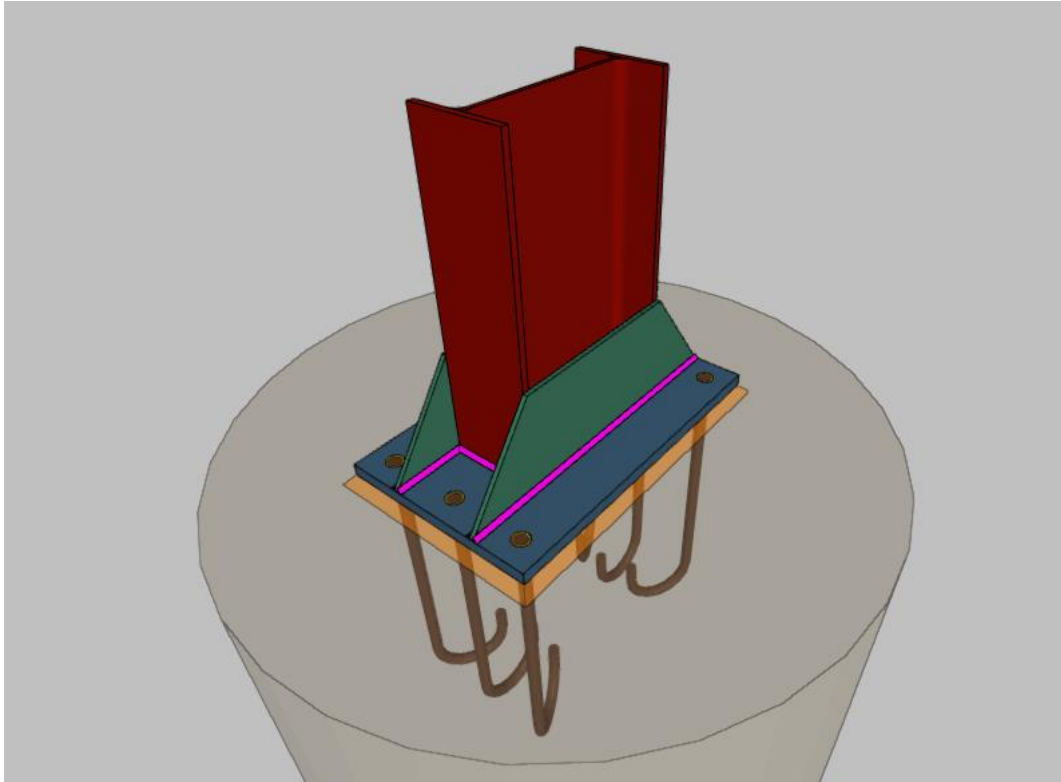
Unión pilar-zapata soldada en obra [7].
